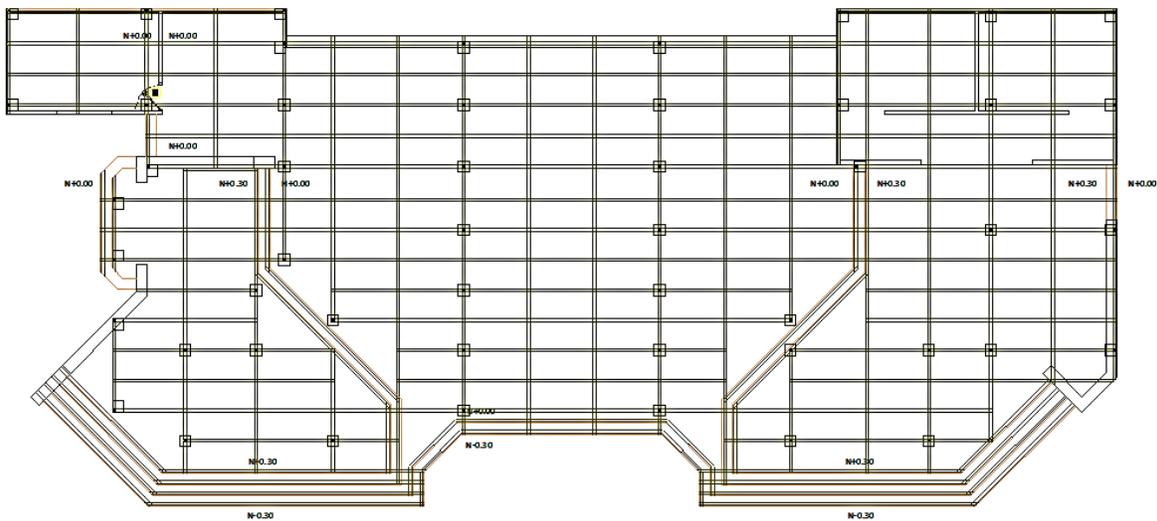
Plano estructural de la plataforma o deck de madera de la palapa. Fuente promovente.
